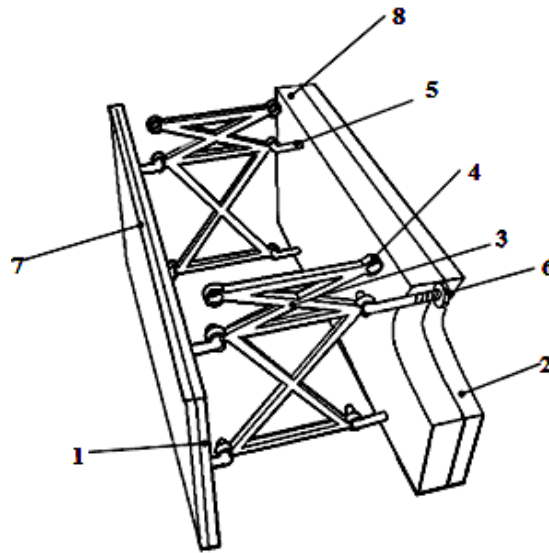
Конструктивна схема блоку модуля з бетонних плит: 1 – зовнішня бетонна плита; 2 – облицювальна плита; 3 – пластина утеплювача; 4 – монтажні крюки; 5 – монтажні проушини; 6 – пластикова стяжка; 7 – закладна гайка; 8 – внутрішня бетонна плита
